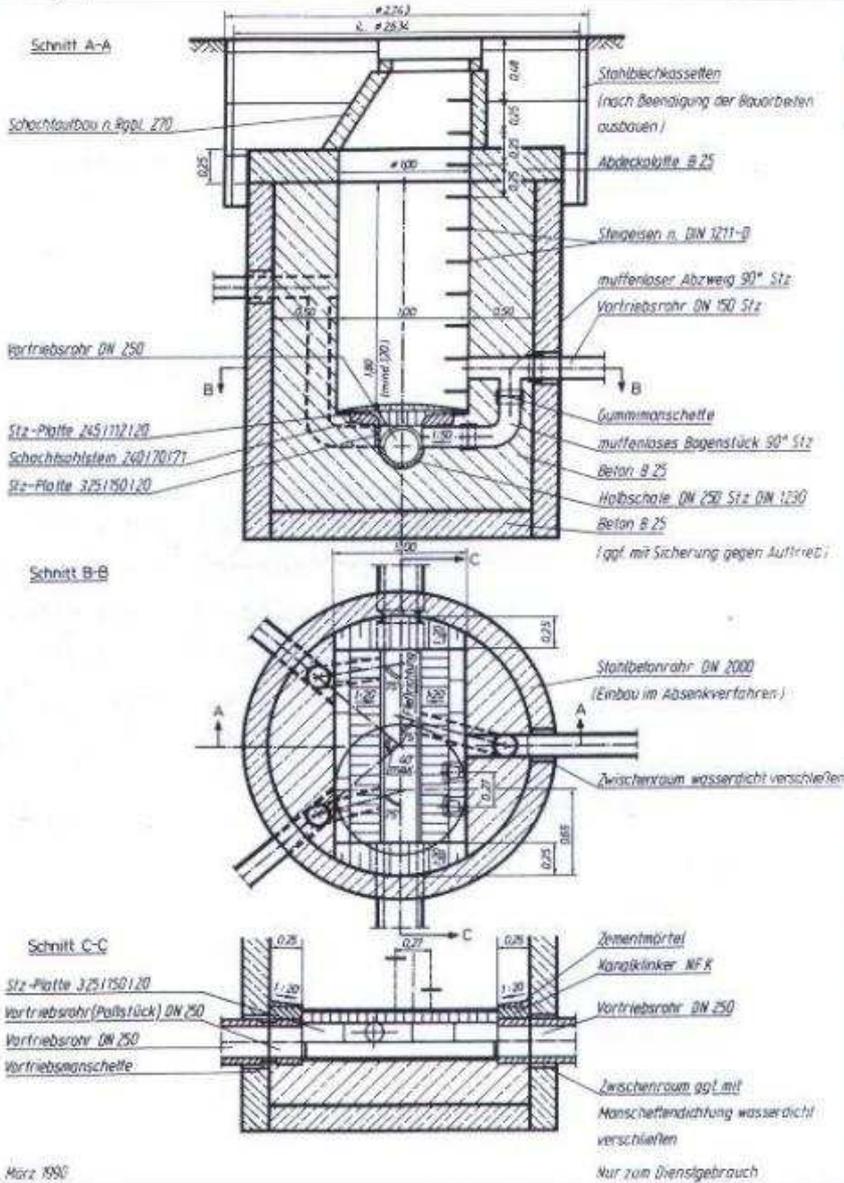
Berliner Bauweise; Start-, Zielschacht ausgebaut als Einsteigschacht
